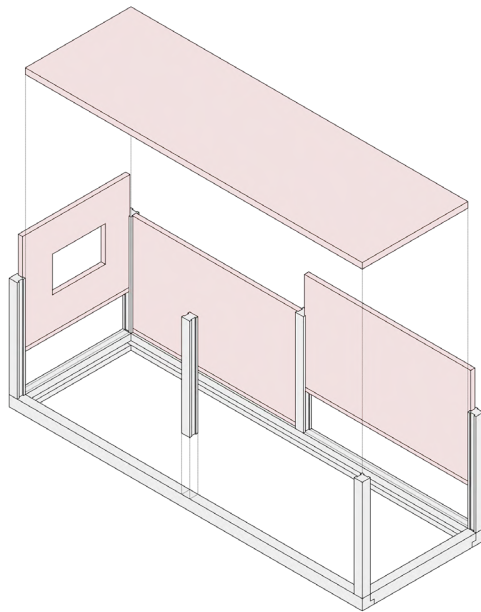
Exemplarische Darstellung eines Raummoduls bestehend aus dem Bauteilkatalog: Primärstruktur (Stütze, Träger, Decke, Wand)
